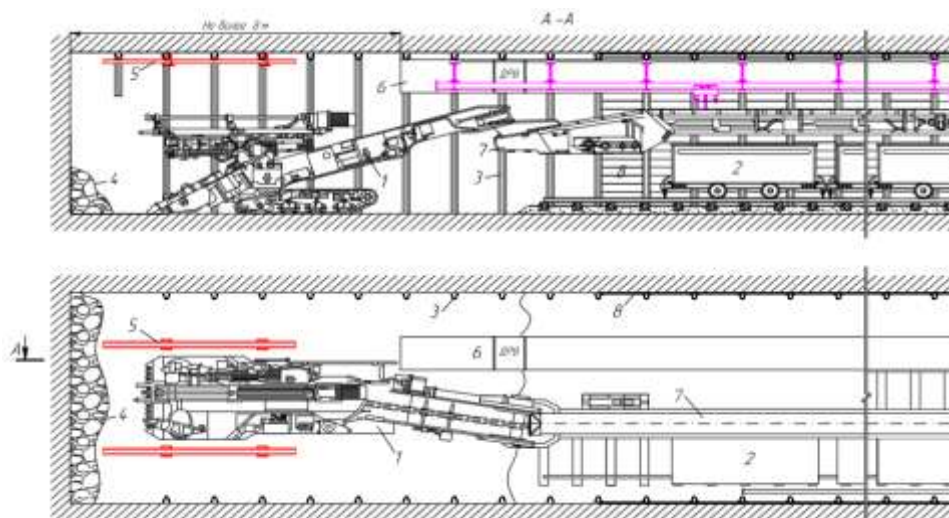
Пример схемы размещения оборудования при проведении выработки буровзрывным способом: 1 – буропогрузочная машина; 2 – вагонетка; 3 – рамная металлическая (арочная) крепь; 4 – отбитая горная масса; 5 – консольная предохранительная (временная) крепь; 6 – вентиляционная труба; 7 – перегружатель; 8 – затяжка (железобетонные блоки)
